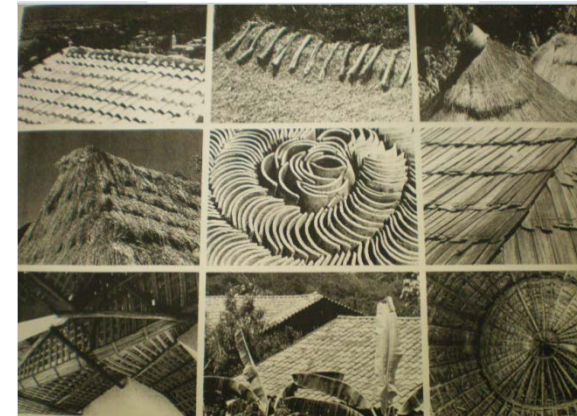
Material regional para la construcción de cubiertas en viviendas de zonas rurales de Guerrero.
